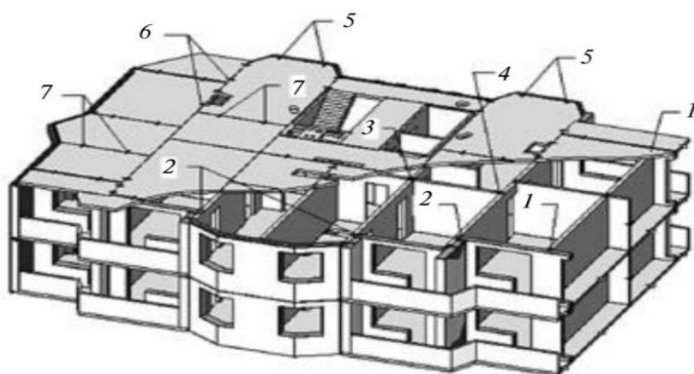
Схема расположения связей в крупнопанельном здании: 1 - между панелями наружных и внутренних стен; 2 - то же, между продольных несущих стен; 3 - между продольных внутренних стен; 4 - между поперечных и продольных внутренних стен; 5 – между наружных стен и плит перекрытий; 6 - между плитами перекрытий вдоль длины здания; 7 - поперек длины здания. В состав такой системы входят:
